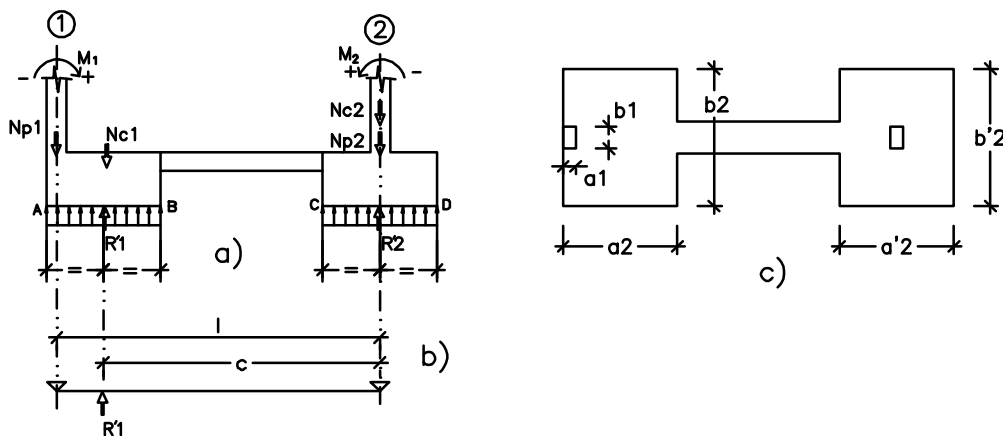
Esquema de cálculo de zapata de medianería con viga centradora.
